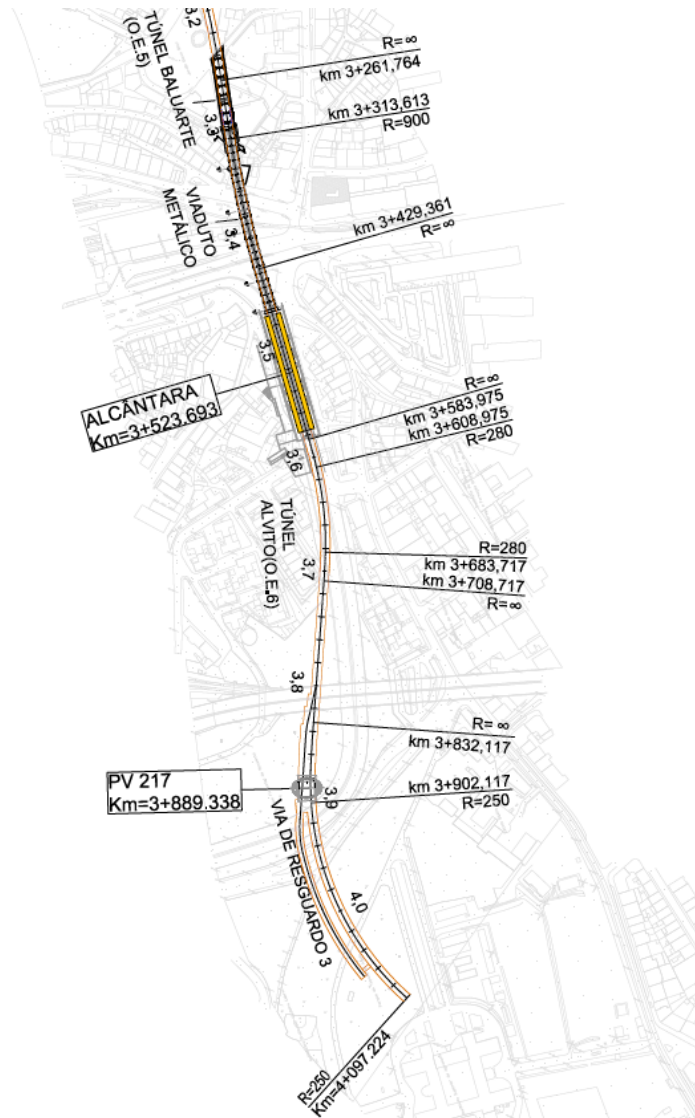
Traçado em planta – 81º Troço: Término – Alcântara
